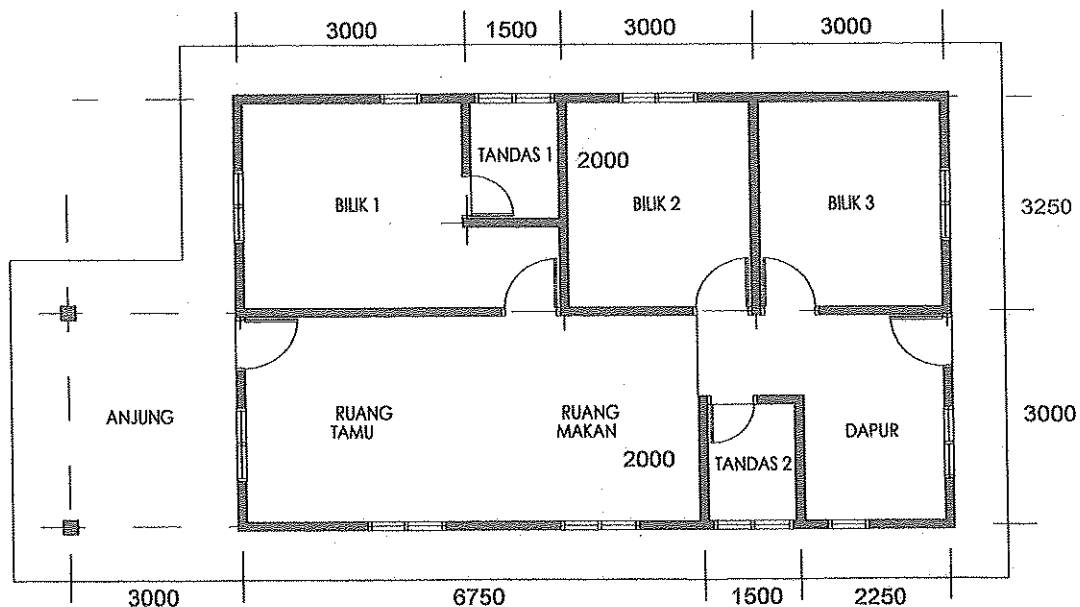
(c) /Rajah B1 (c): Floor Plan /Pelan lantai
